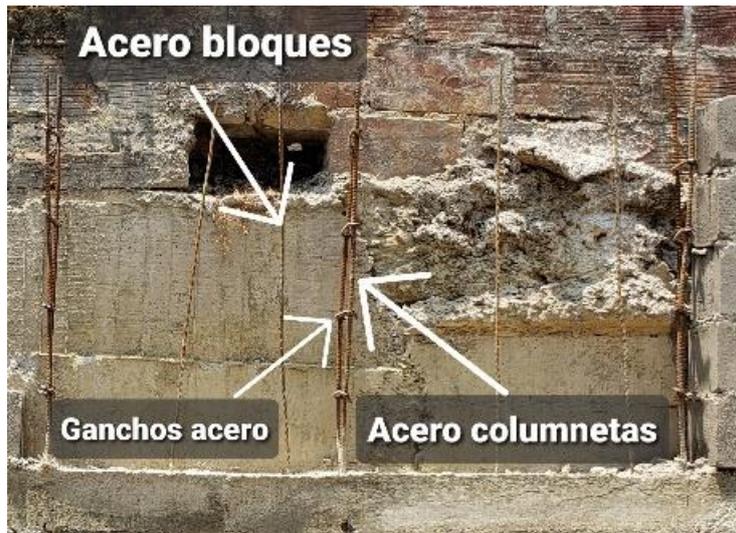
Refuerzo de acero muro de contención tipo cortina
